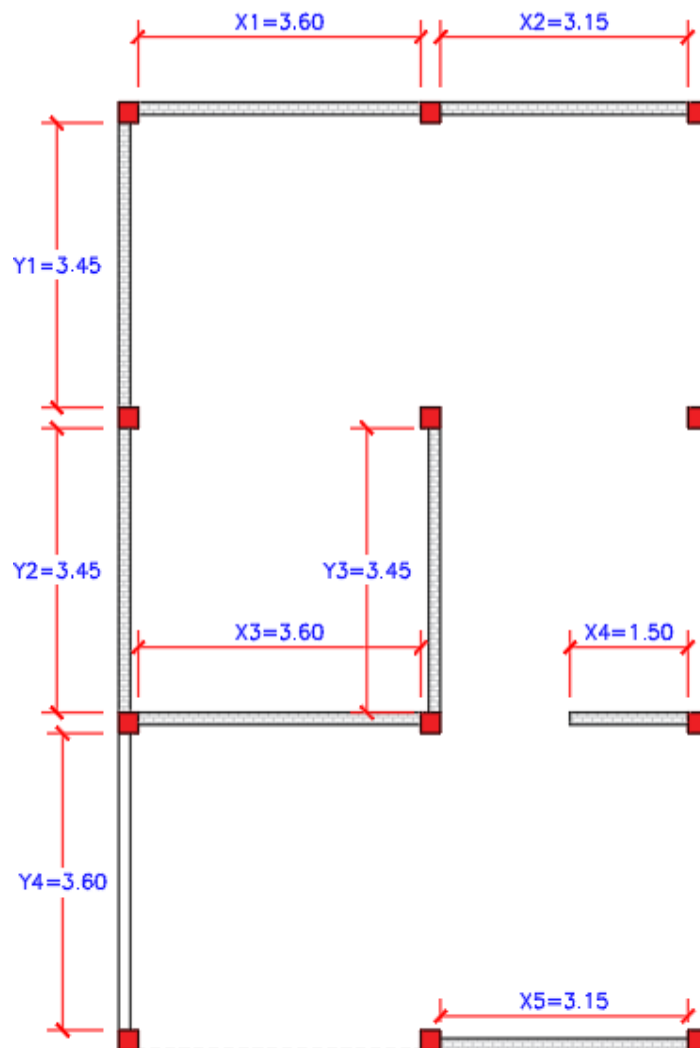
Muros portantes de Vivienda 1, vista de planta.
